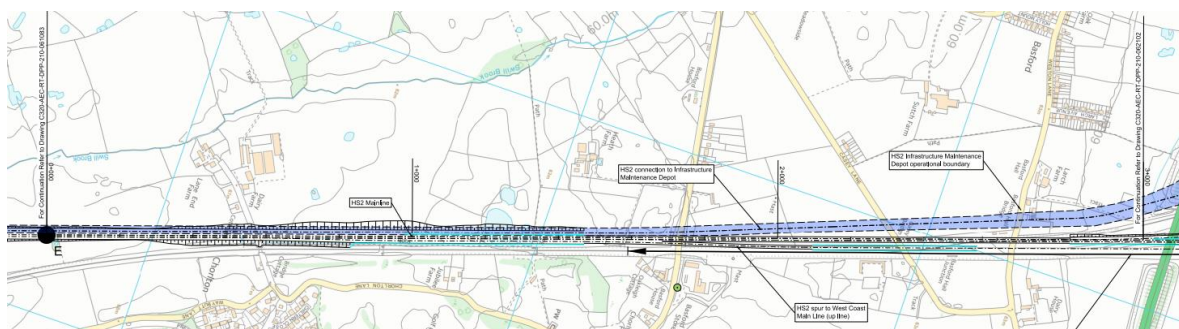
9 - Planta do traçado do viaduto sobre a linha ferroviária existente na área de Chorlton (Unido, HSM10 Sheet 1).
